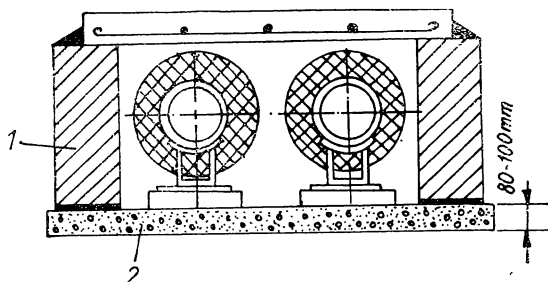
Canal de protecție cu pereți laterali și planșeu prefabricat din beton armat:
